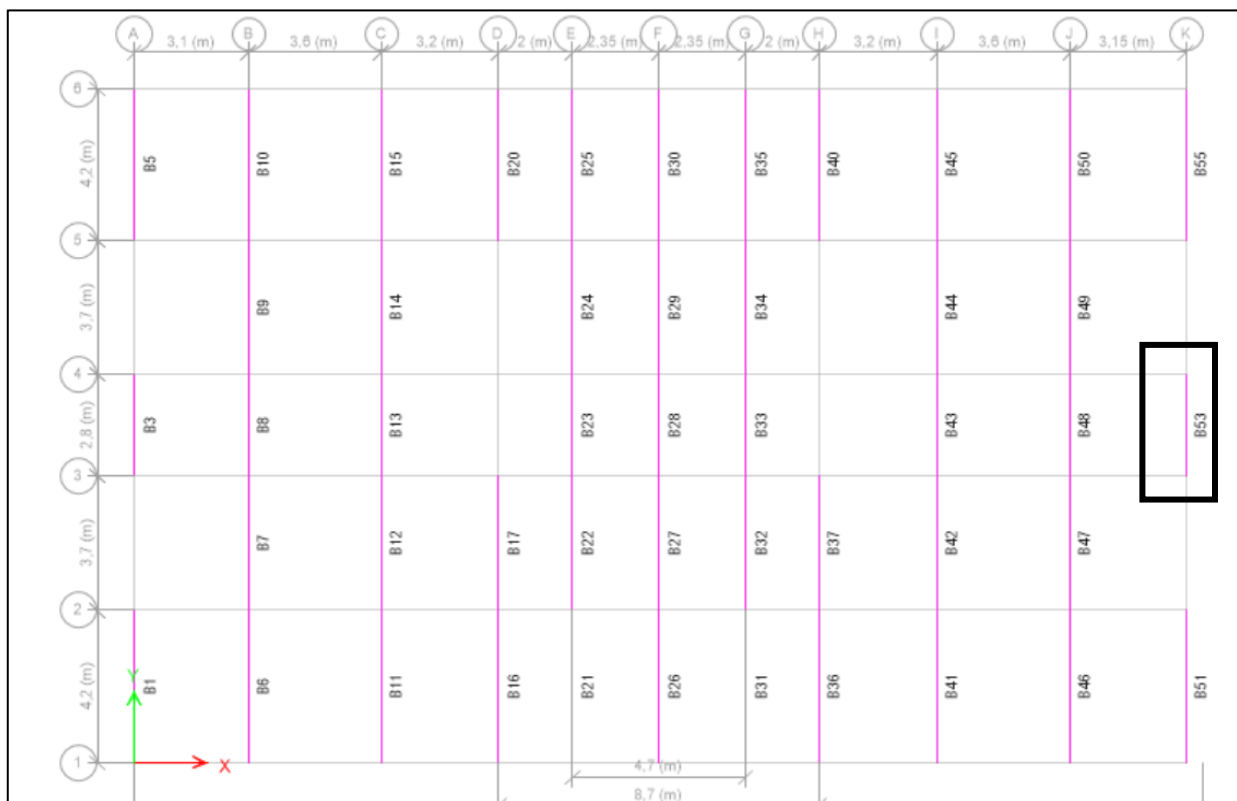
Disposition des poutres principales au RDC (Exemple B53)
